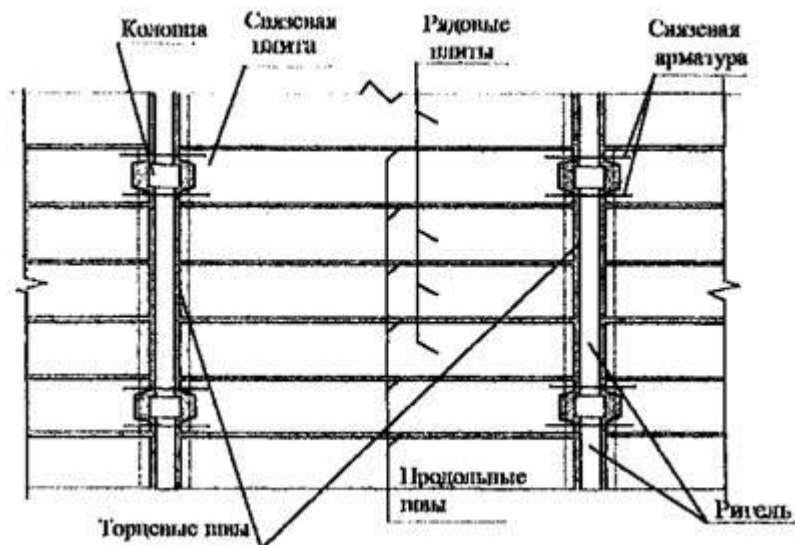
Фрагмент плана сборного перекрытия из многопустотных плит
